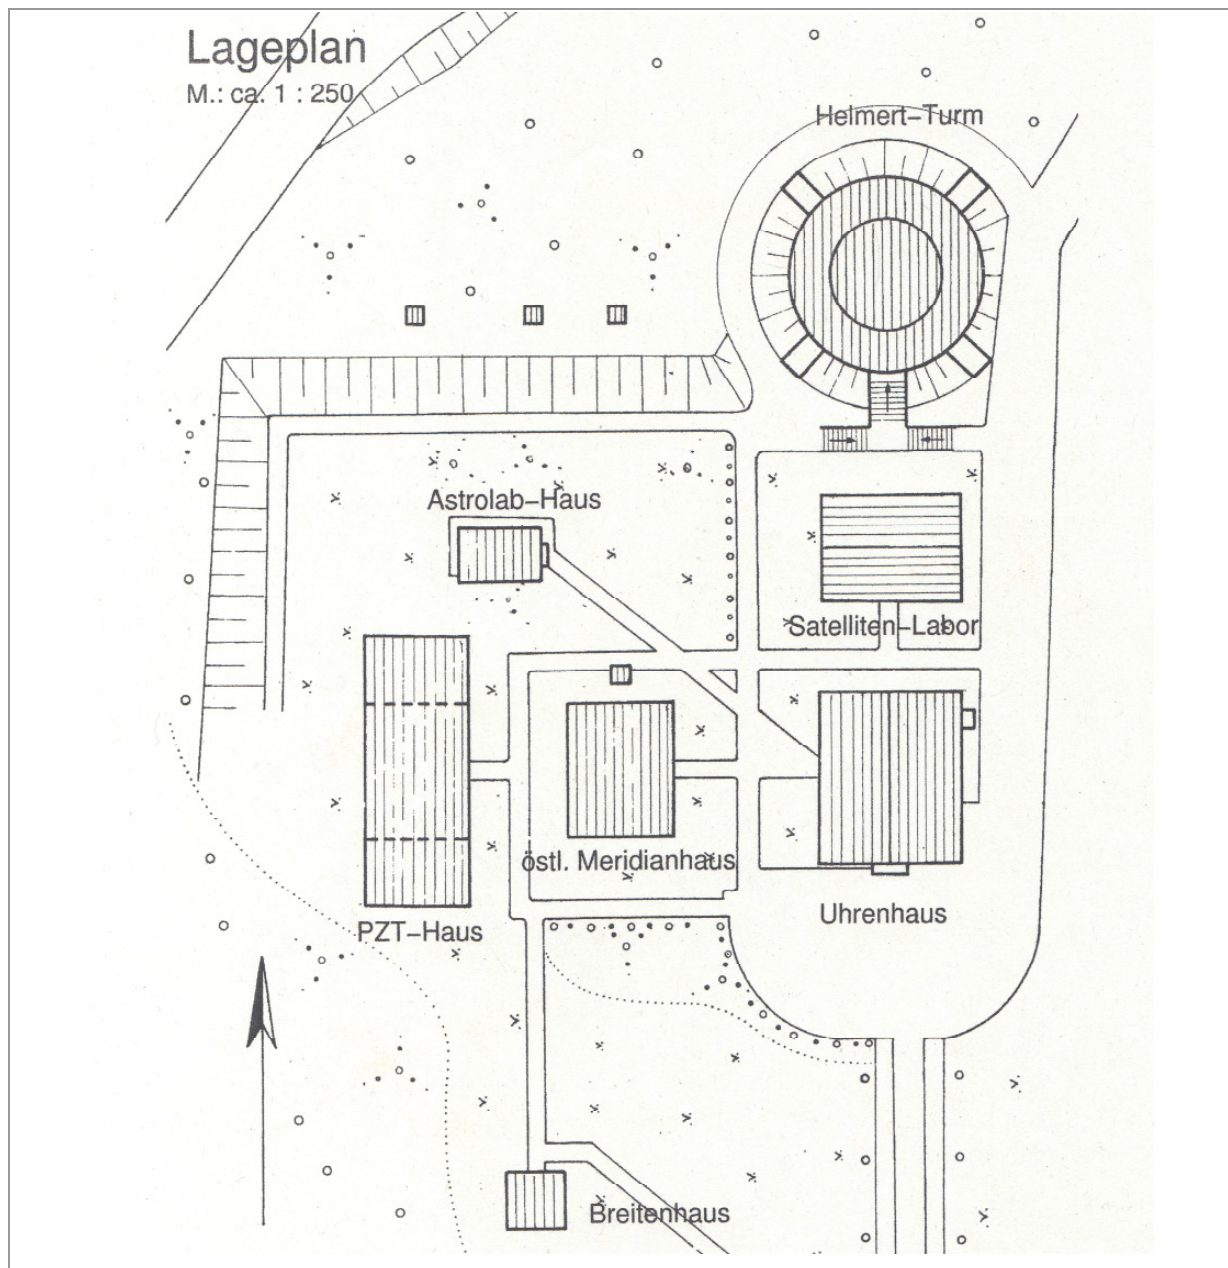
Lageplan der Beobachtungshäuser für Zeit- und Breitenbestimmungen. Vor 2004. Östl. Meridianhaus heute noch erhalten. Ehemaliges west. Meridianhaus umgebaut zum PZT-Haus. Astrolab-Haus: 1957 gebaut und 2004 abgerissen. GIP-Geschichte von J. Höpfner, S. 83.
